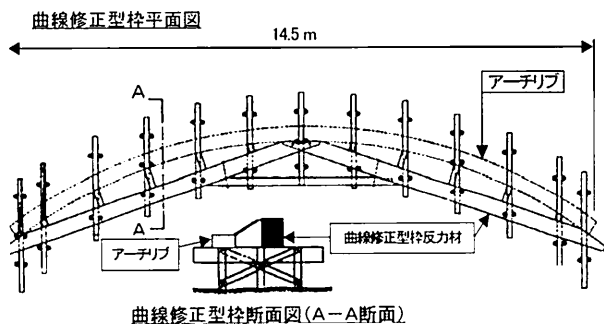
アーチリブ曲線修正型枠 (平面図・断面図)
